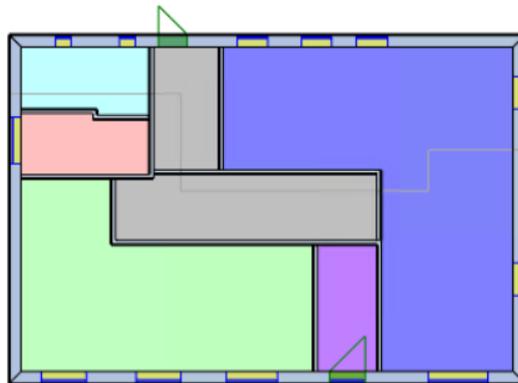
Grundriss Erdgeschoss, zoniert
